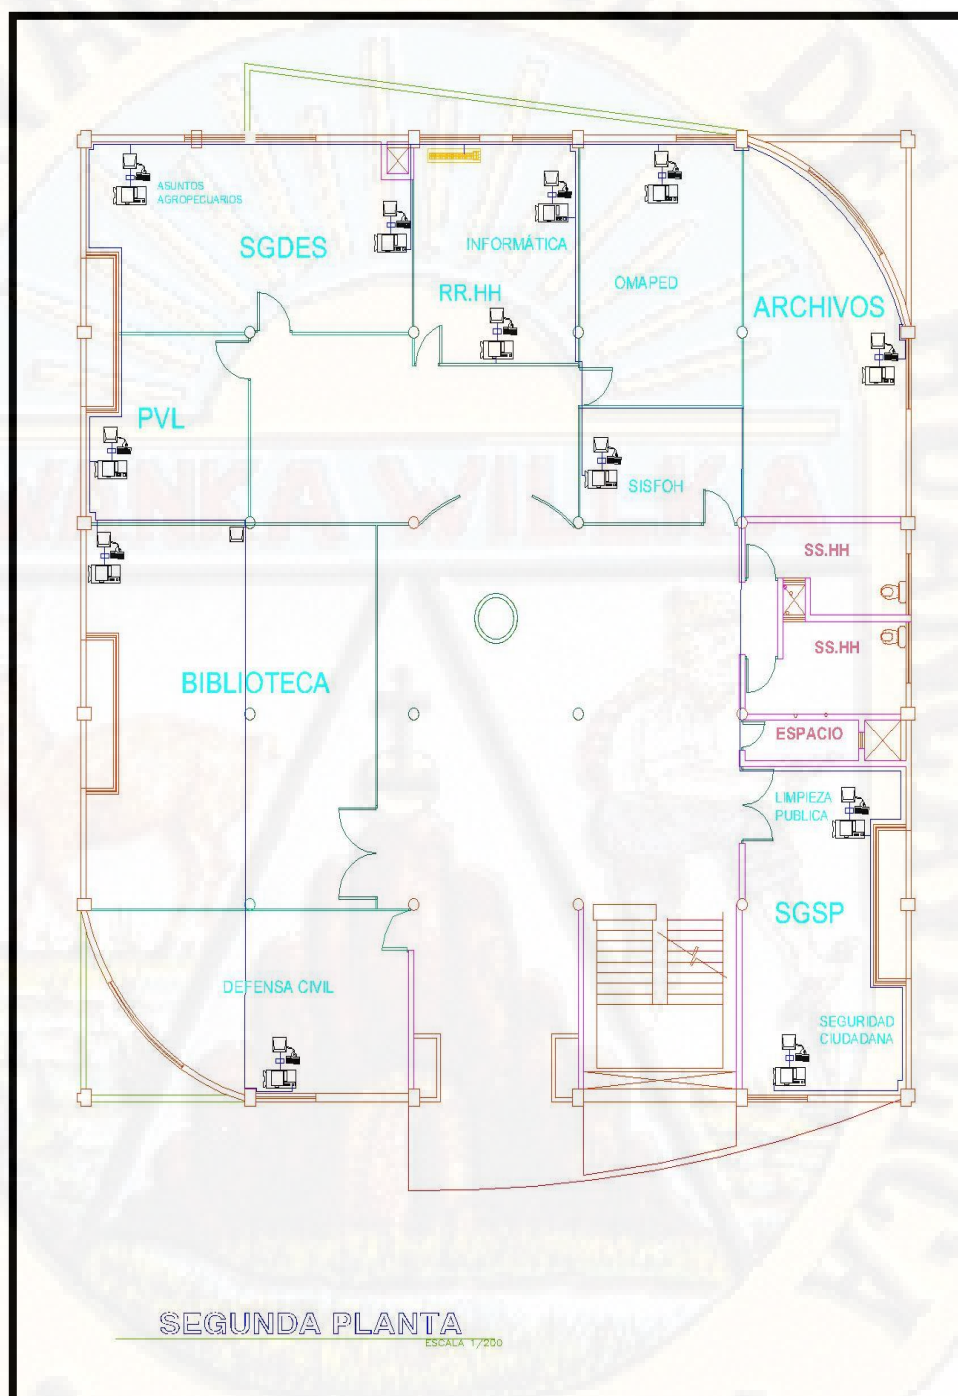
Plano de ubicación de la Segunda planta del edificio de la MDDH
